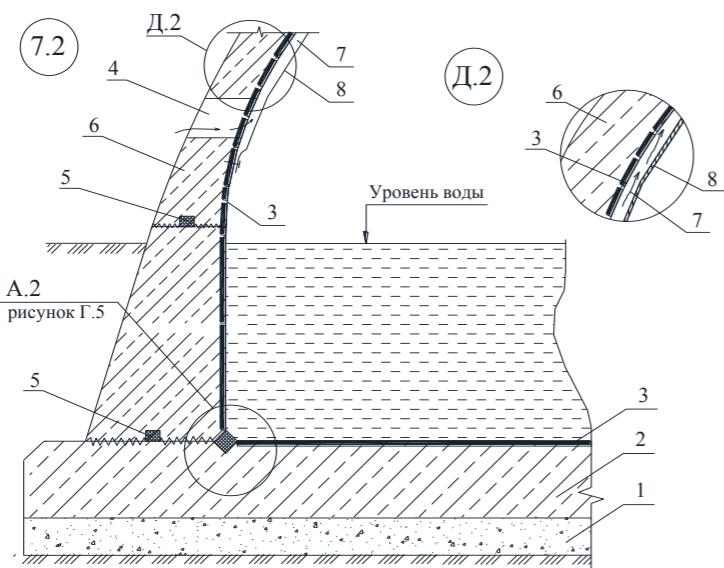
Узел 7.1 Гидроизоляция монолитной фундаментной плиты и монолитной стены бассейна башенной градирни
